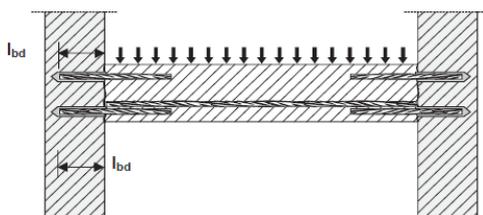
Ancrage d'armatures en extrémité de dalles ou de poutres, conçu en appui simple, d'après le DEE 330087-02-0601 [1]
